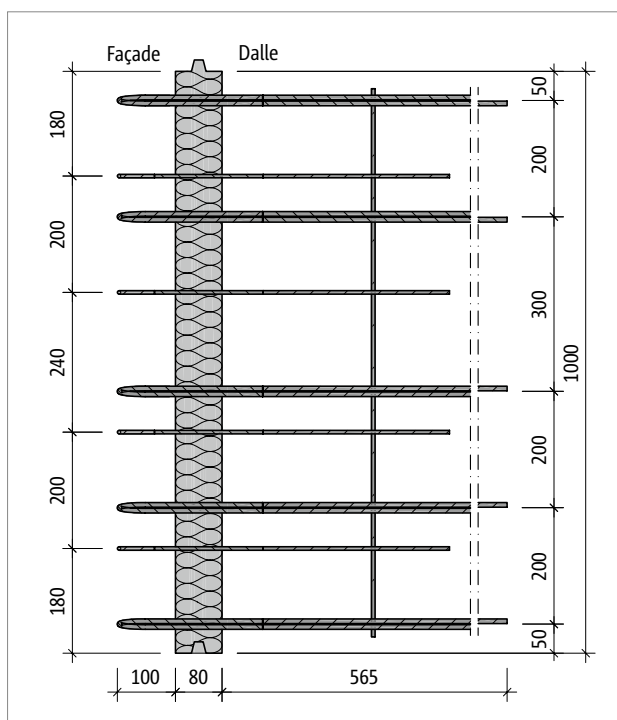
Schöck Rutherma® T type DF-V3-LR100 : vue en plan du produit
